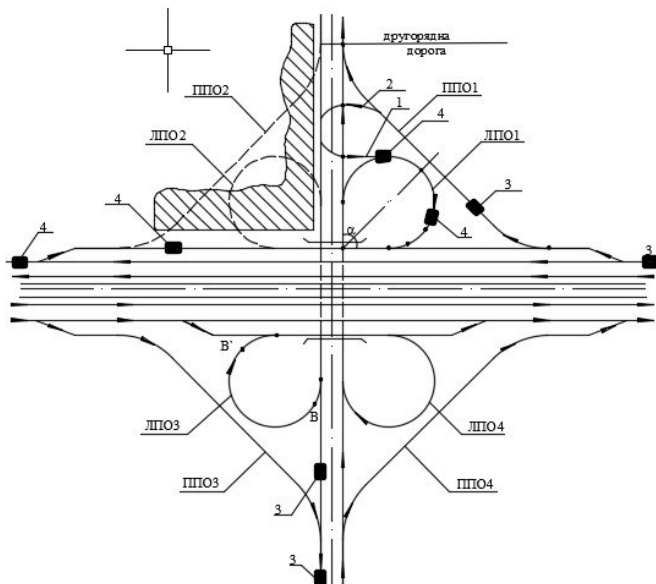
Схема транспортної розв'язки «неповний лист конюшини» з трьома ЛПО: 1 – неповний правоповоротний з'їзд НППО; 2 – неповний лівоповоротний з'їзд НЛПО; 3 – автомобілі, що повертають ліворуч з головної дороги на другорядну; 4 – автомобілі, що повертають праворуч з другорядної дороги на головну
